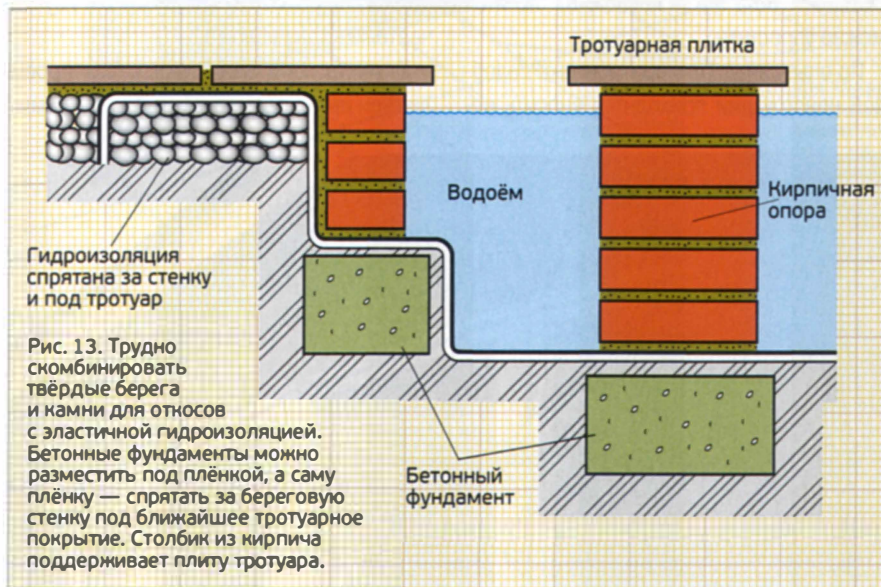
Трудно скомбинировать твёрдые берега и камни для откосов с эластичной гидроизоляцией. Бетонные фундаменты можно разместить под плёнкой, а саму плётку — спрятать за береговую стенку под ближайшее тротуарное покрытие. Столбик из кирпича поддерживает плиту тротуара.
